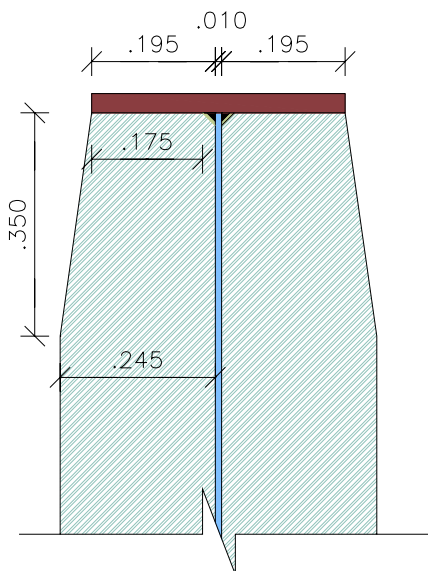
Sección transversal de viga con rigidizadores de apoyo
